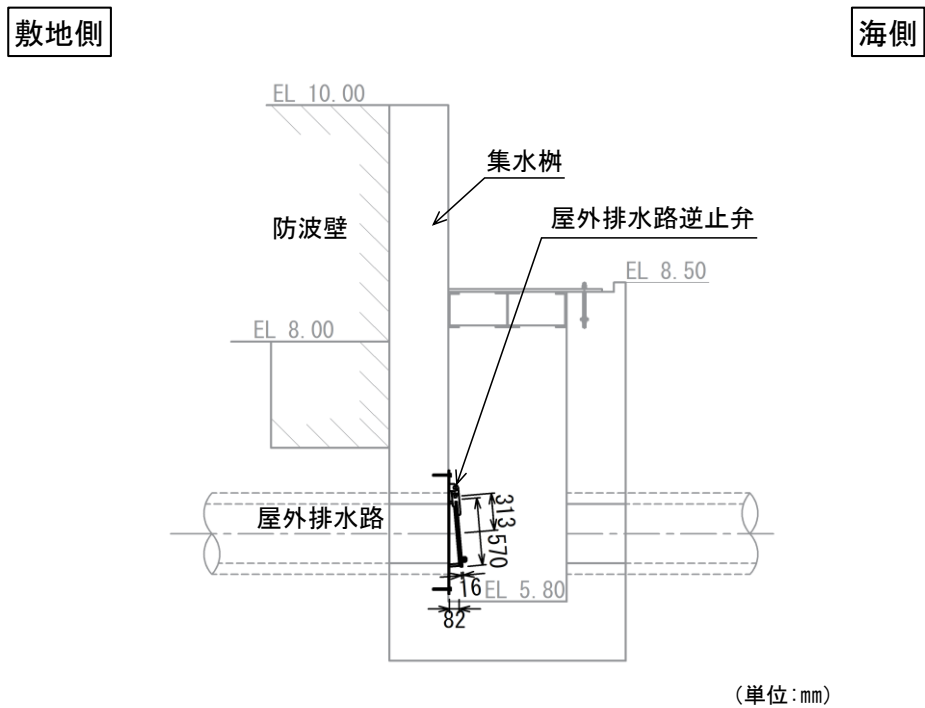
(1) 屋外排水路逆止弁⑧-1 断面図
